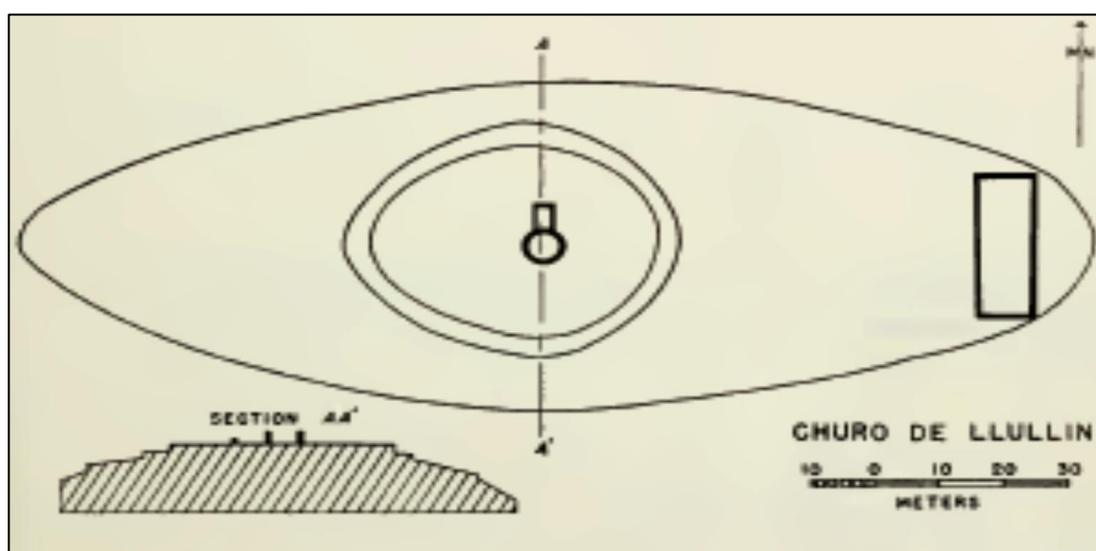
Plano y sección del Churo de Llullín en Zula, provincia de Chimborazo
